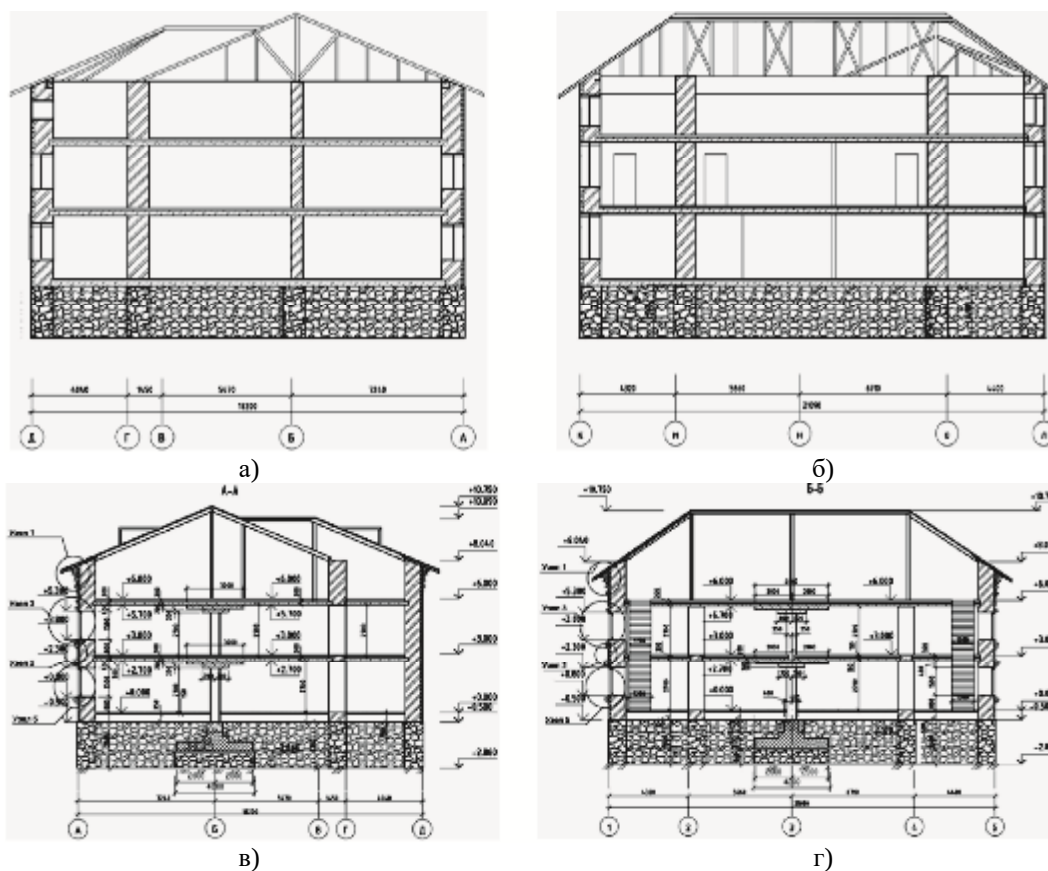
Разрезы по зданию: а) и б) соответственно, поперечный и продольный, до реконструкции;
